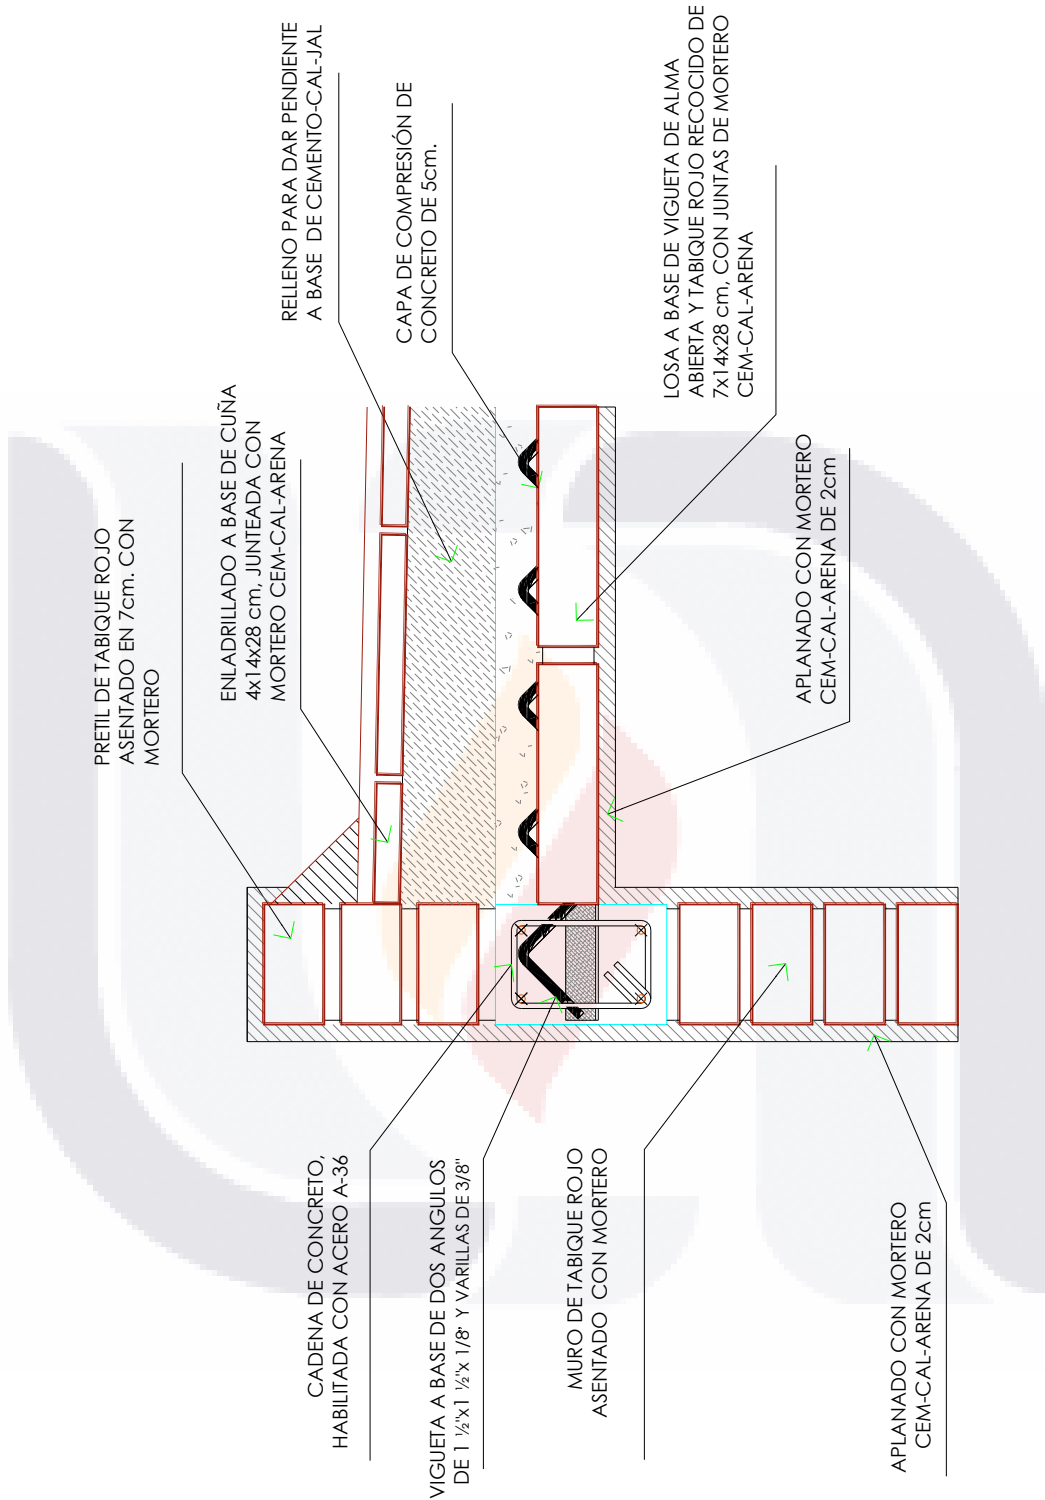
Detalle arquitectónico de la estructura de la losa de azotea
